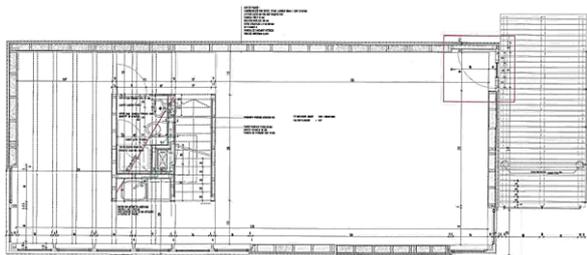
Grundriss Erdgeschoss, Plan vom 10.09.1998 aus der Projektdokumentation vom 26.09.2018 (Privatarchiv Lis Kocher)
